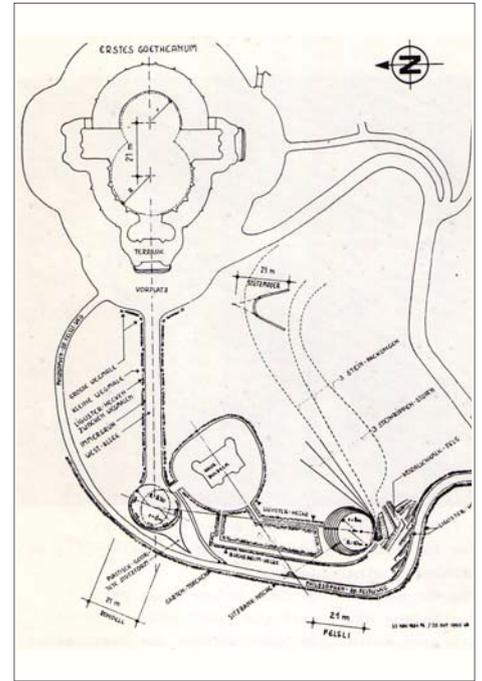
Rudolf Steiner - Planimetria, Situazione paesaggistica Goetheanum Duldeck Haus-Fesli. Dornach, Svizzera.
